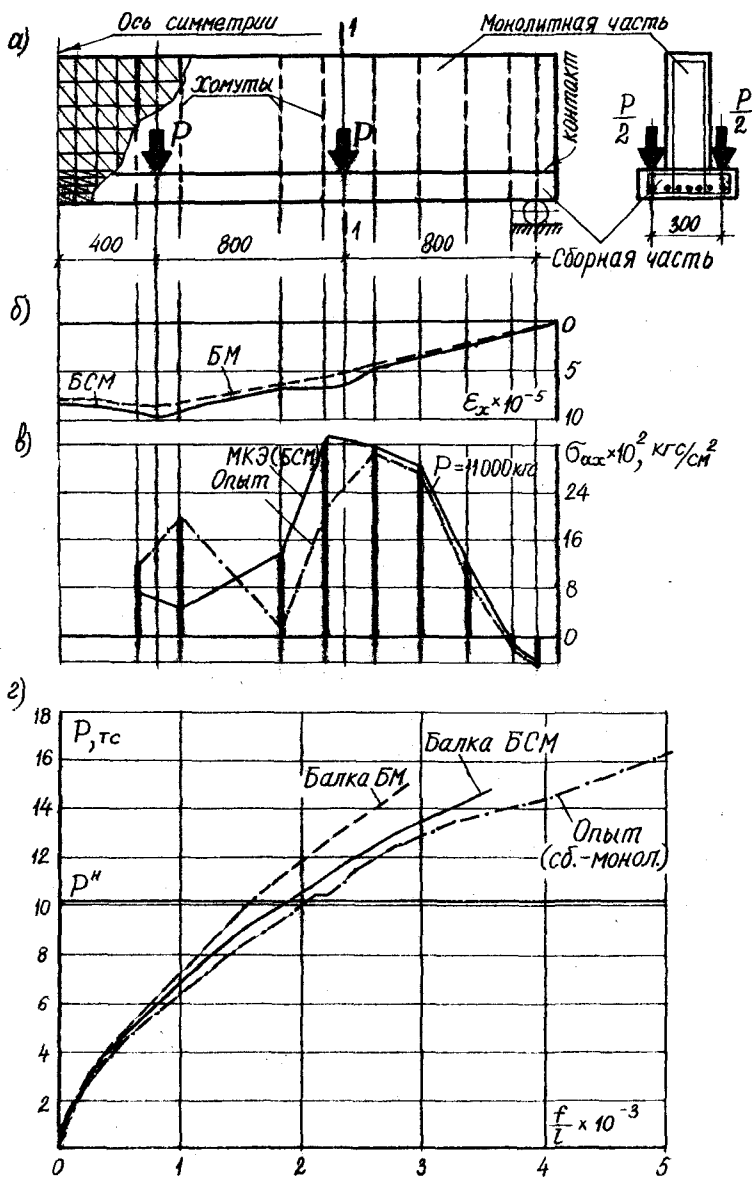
Расчет сборно-монолитной железобетонной балки: а) - исходная балка; б) - деформации  $E_x$  нижнего волокна бетона при  $P = 2000 \text{ кг}$ ; в) - напряжения в хомутах; г) - прогибы балок
